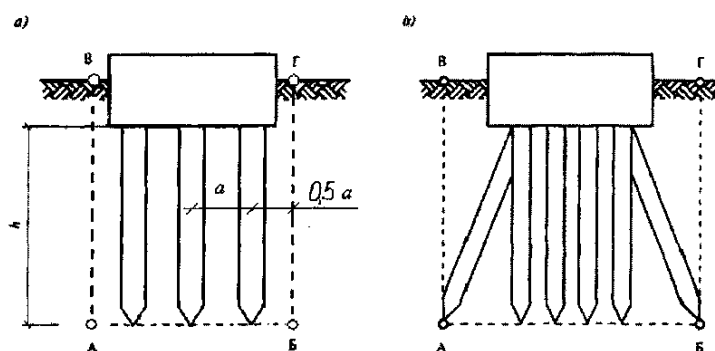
Определение границ условного фундамента при расчете осадки свайных фундаментов.
